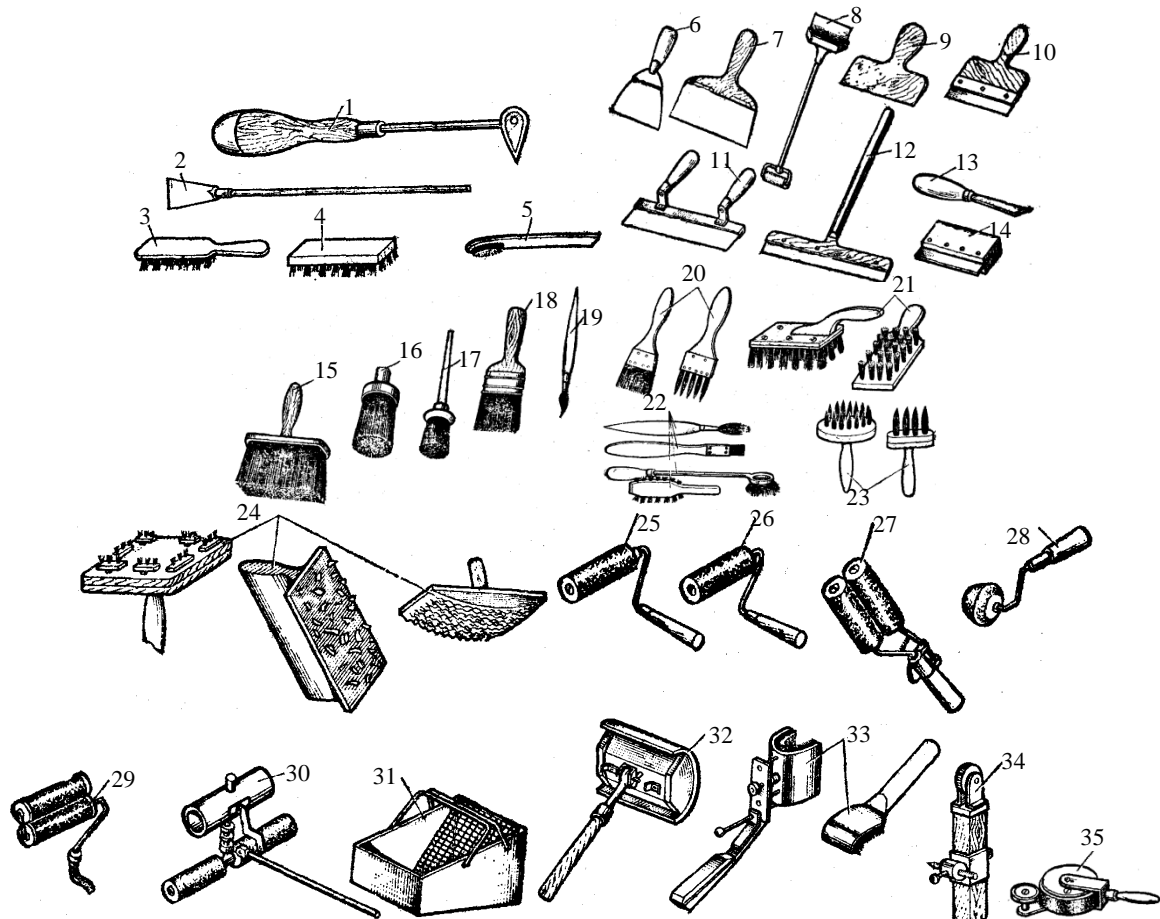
Ручні інструменти для малярських робіт: 1 – фігурна скребачка; 2 – скребачка з подовженим держаком; 3–5 – сталеві щітки; 6,7 – сталевий шпатель; 8 – шпатель з ванночкою для стель; 9 – дерев’яний шпатель з гумовим або пластмасовим наконечням; 10 – шпатель зі змінним лезом; 11 – комбінований шпатель; 12 – подовжений дерев’яний шпатель з пластмасовим наконечням і подовженим держаком; 13 – штукатурний ніж; 14 – гумовий шпатель; 15 – макловиця; 16 – маховий пензель; 17 – пензель-ручник; 18 – пензель-флейц; 19 – фільоночний пензель; 20 – шеперка; 21 – торцювання; 22 – пензлі для забарвлювання радіаторів; 23 – складальні торцювання; 24 – фактурні торцювання; 25, 26 – валики; 27 – те саме, для фарбування радіаторів, труб та решіток; 28 – валик кутовий; 29 – те саме з пневмоподачею фарби; 30 – те саме для фарбування підлог; 31 – ванночка з решіткою; 32 – пристосування для шліфування труб; 33 – те саме для шліфування поверхні; 34, 35 – те саме для відбивання й шліфування фільонок
